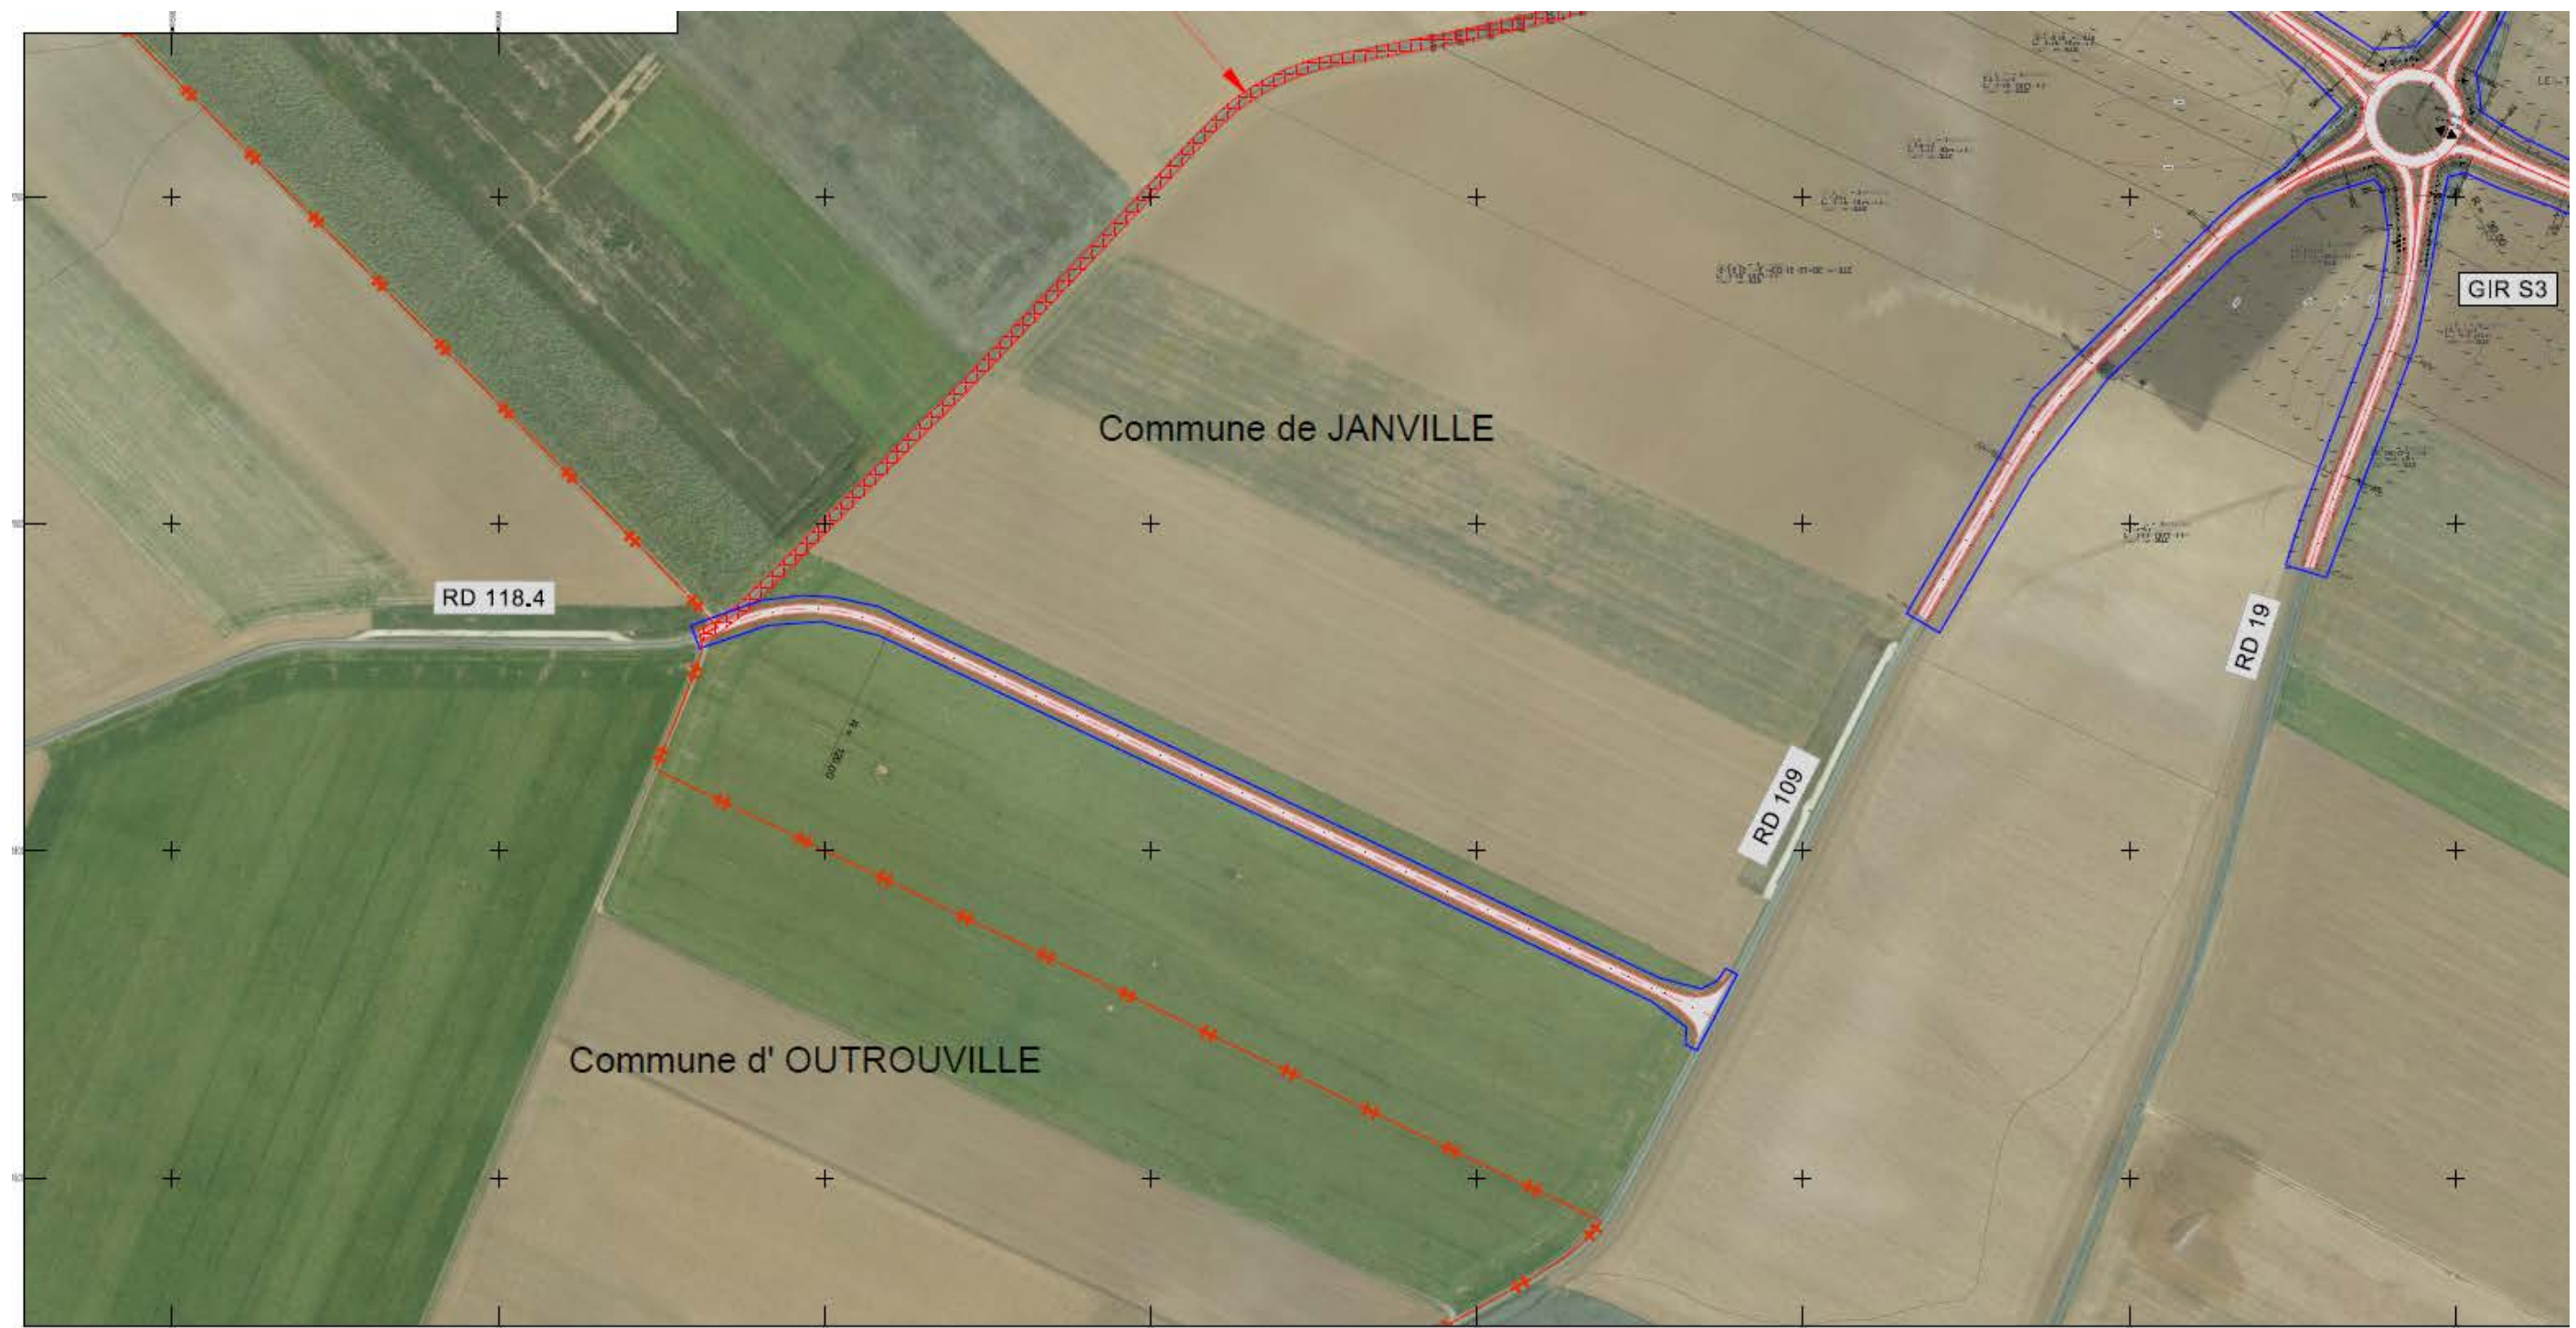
Vue en plan de la déviation de Janville - Le Puiset (planche 3)
